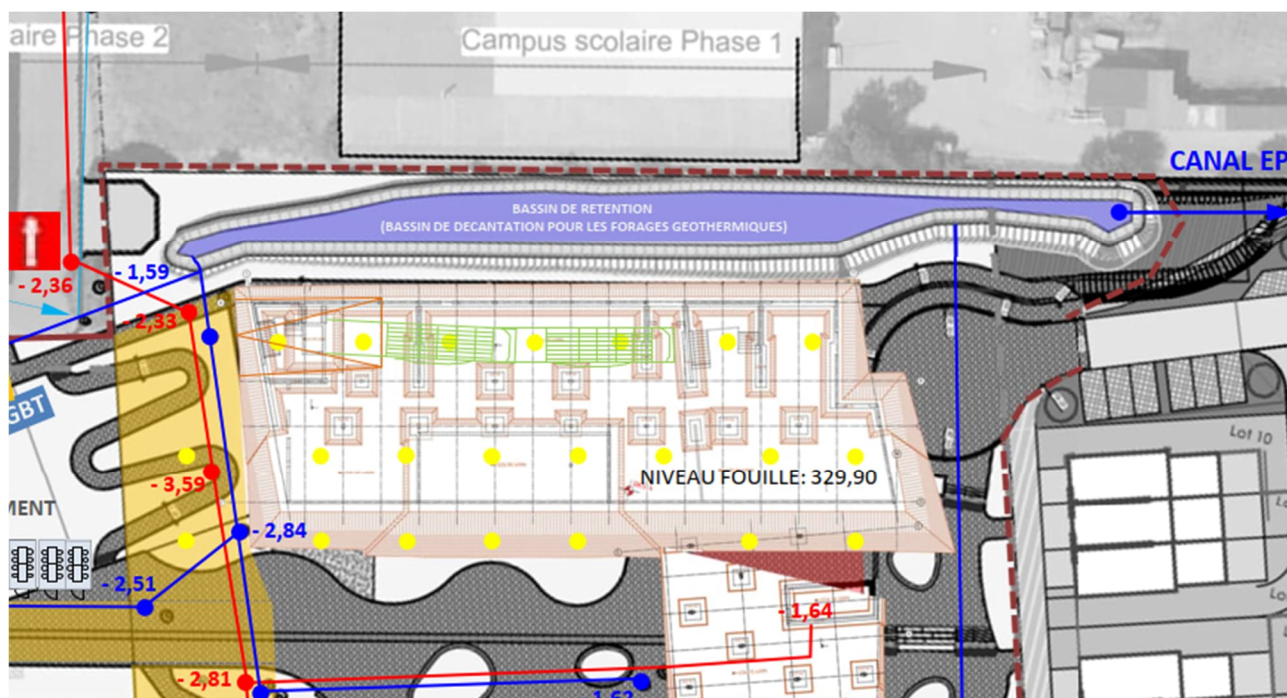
Plan d'installation de chantier (extrait du plan d'installation de chantier n°25/0470-01C – Schroeder & associés – 24/03/2025)
